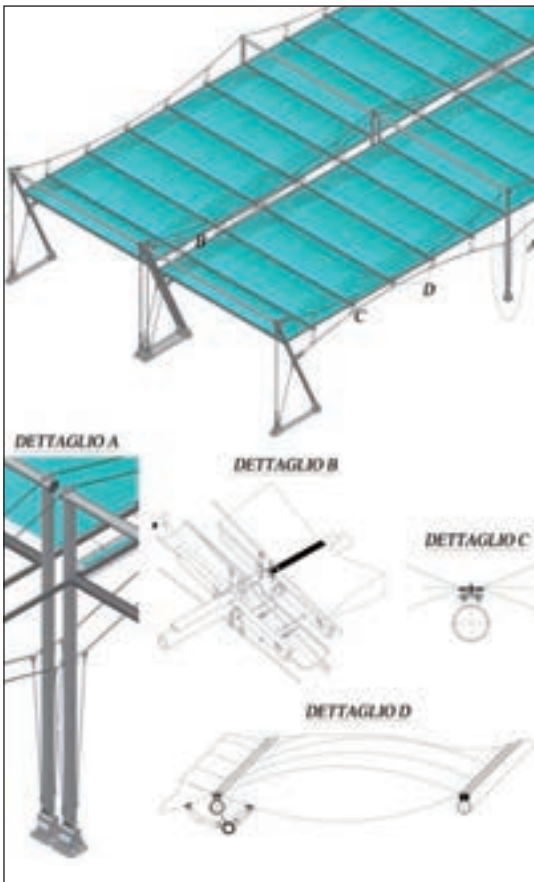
Assonometria e dettagli costruttivi delle strutture di copertura dell'accesso Ovest
